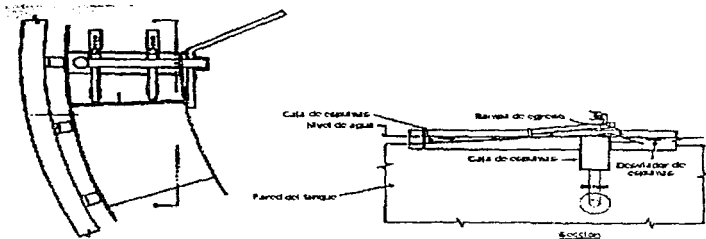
MECANISMO RASANTE CONVENCIONAL PARA TANQUES CIRCULARES
